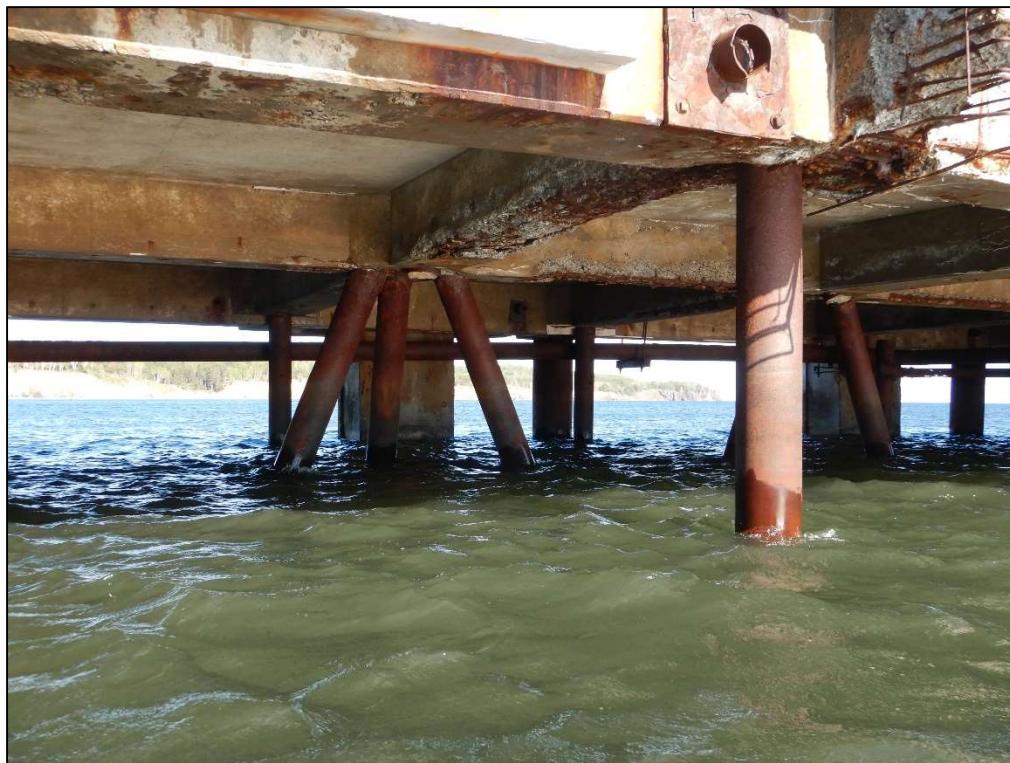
TRAVÉE N°54 – ZONE D’ÉCLATEMENT AVEC ARMATURES APPARENTES SECTIONNÉES
